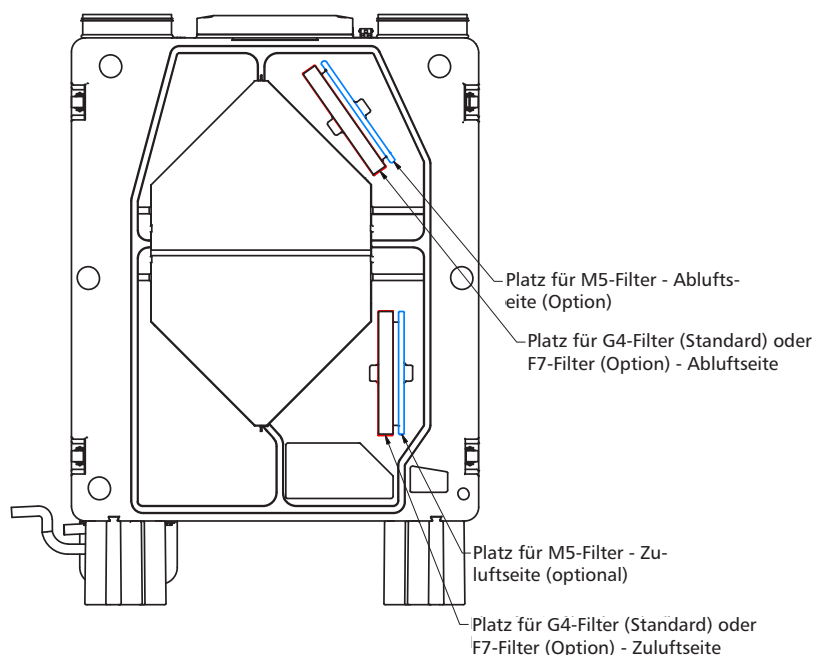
Filterpositionen (Ansicht ohne Frontabdeckung)
